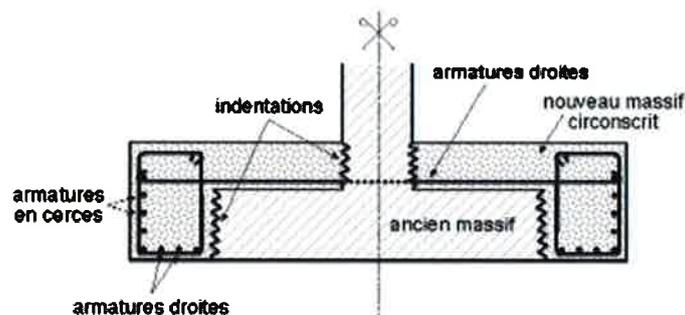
augmentation de la surface de la semelle avec surépaisseur.
